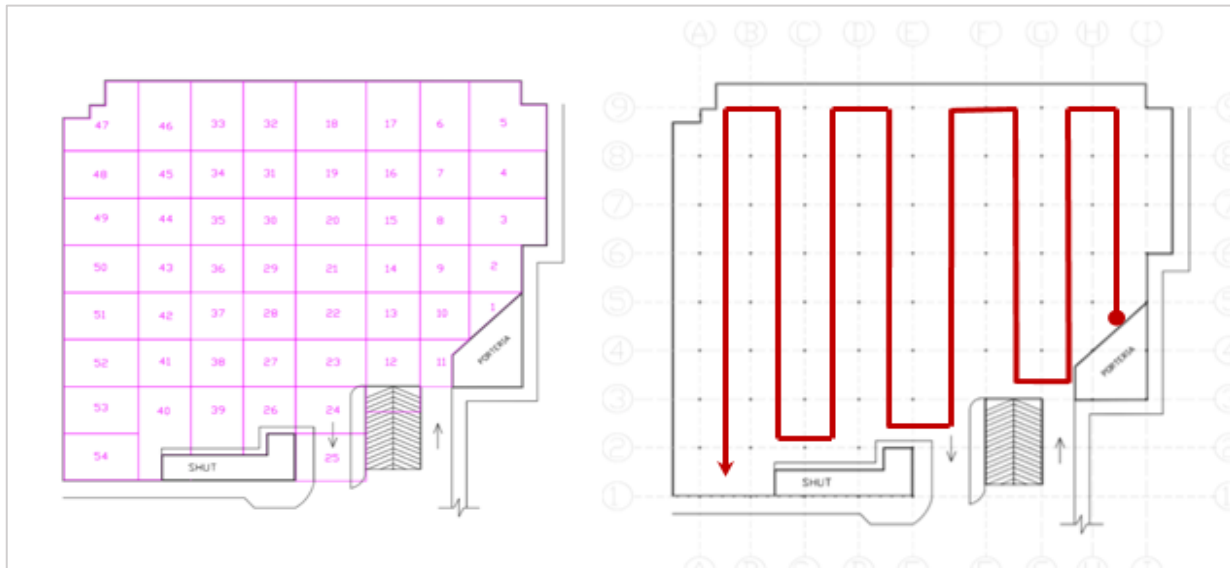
Levantamiento planta de primer nivel cuadrantes (izq) y recorrido realizado (der). Fuente: Elaboración propia.
